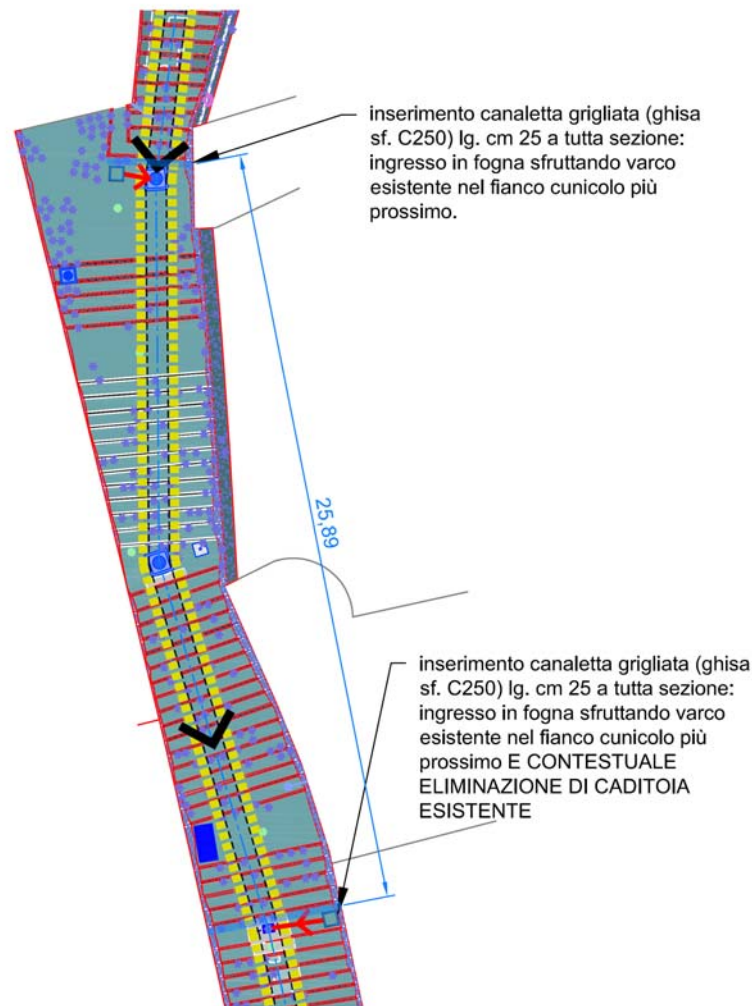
estratto da planimetria di progetto Calata S. Francesco
